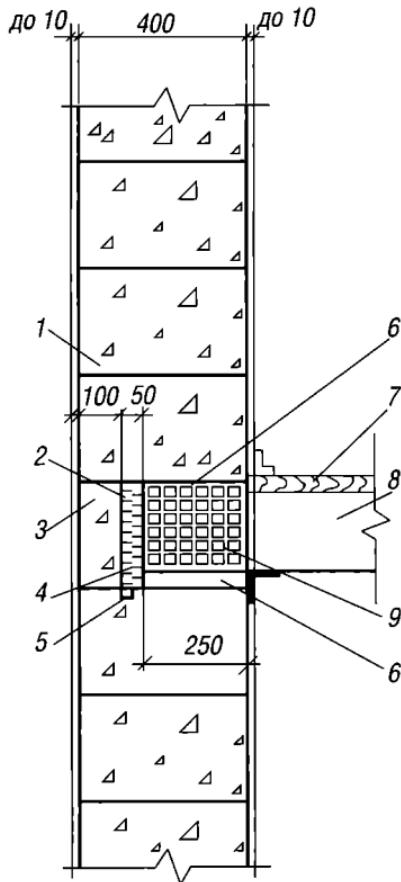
Узел опирания деревянной балки перекрытия на стену из ячеистобетонных блоков:
